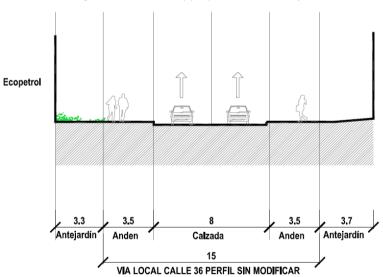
Perfil actual y propuesto Calle 36. Tipo V-7
